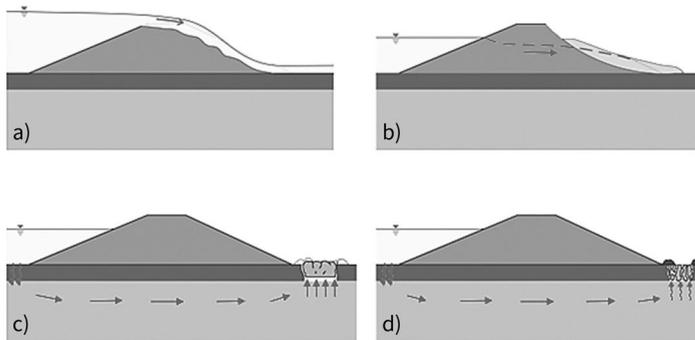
Mögliche Versagensmechanismen bei Hochwasserschutzdämmen (nach [7]), a) Überströmen des Damms (Erosionsbruch), b) Böschungsbruch infolge Sickerwasser, c) Hydraulischer Grundbruch infolge Auftrieb (Aufschwimmen), d) Hydraulischer Grundbruch infolge Erosion/Suffosion
